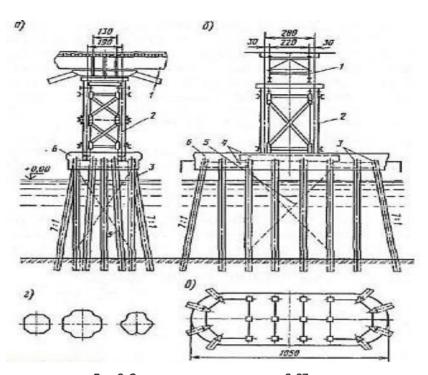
Опора под пролетные строения 2х27: а) – фасад; б) – поперечный вид; в) – план; г) – сечение свай; 1 – пролетные строения; 2 – верхняя часть опоры; 3 – сваи; 4 – металлический ростверк; 5 – подводные связи; 6 – железобетонный ростверк.
